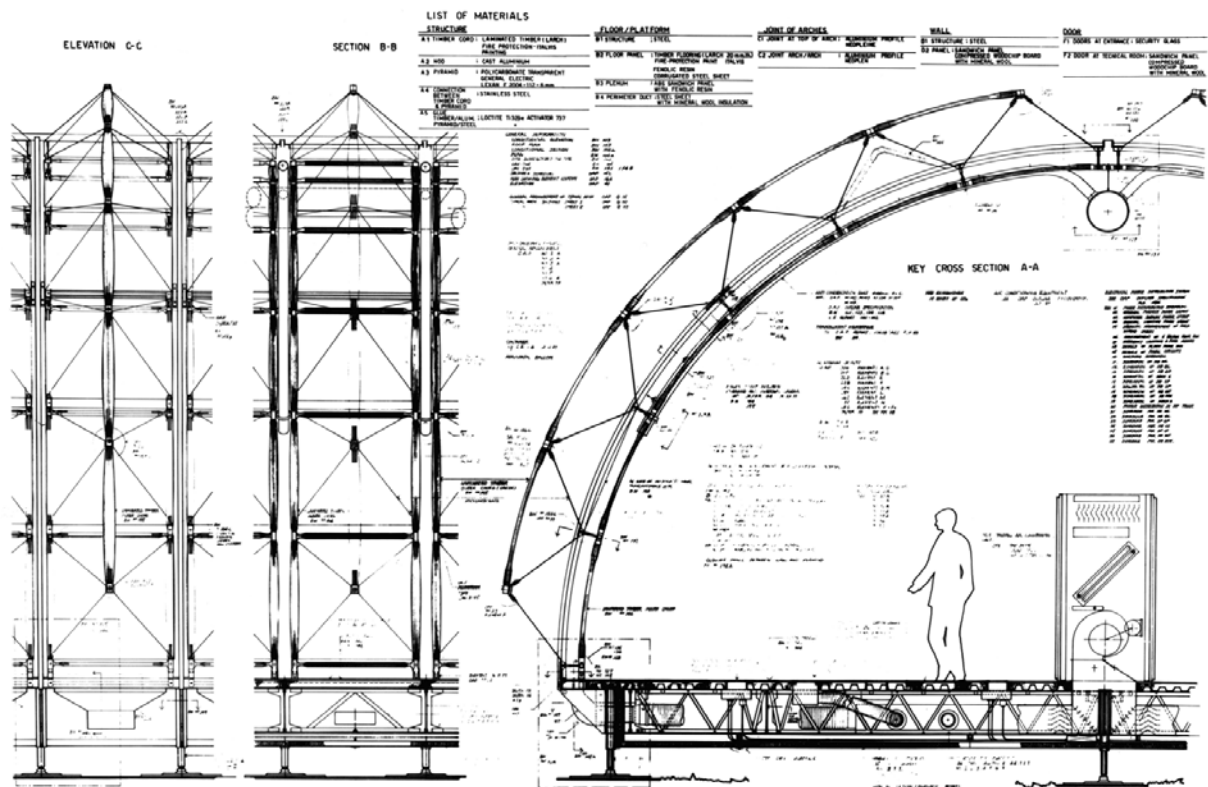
Montagem do Pavilhão IBM. Renzo Piano, 1992 (Renzo Piano Building Workshop, architects).
